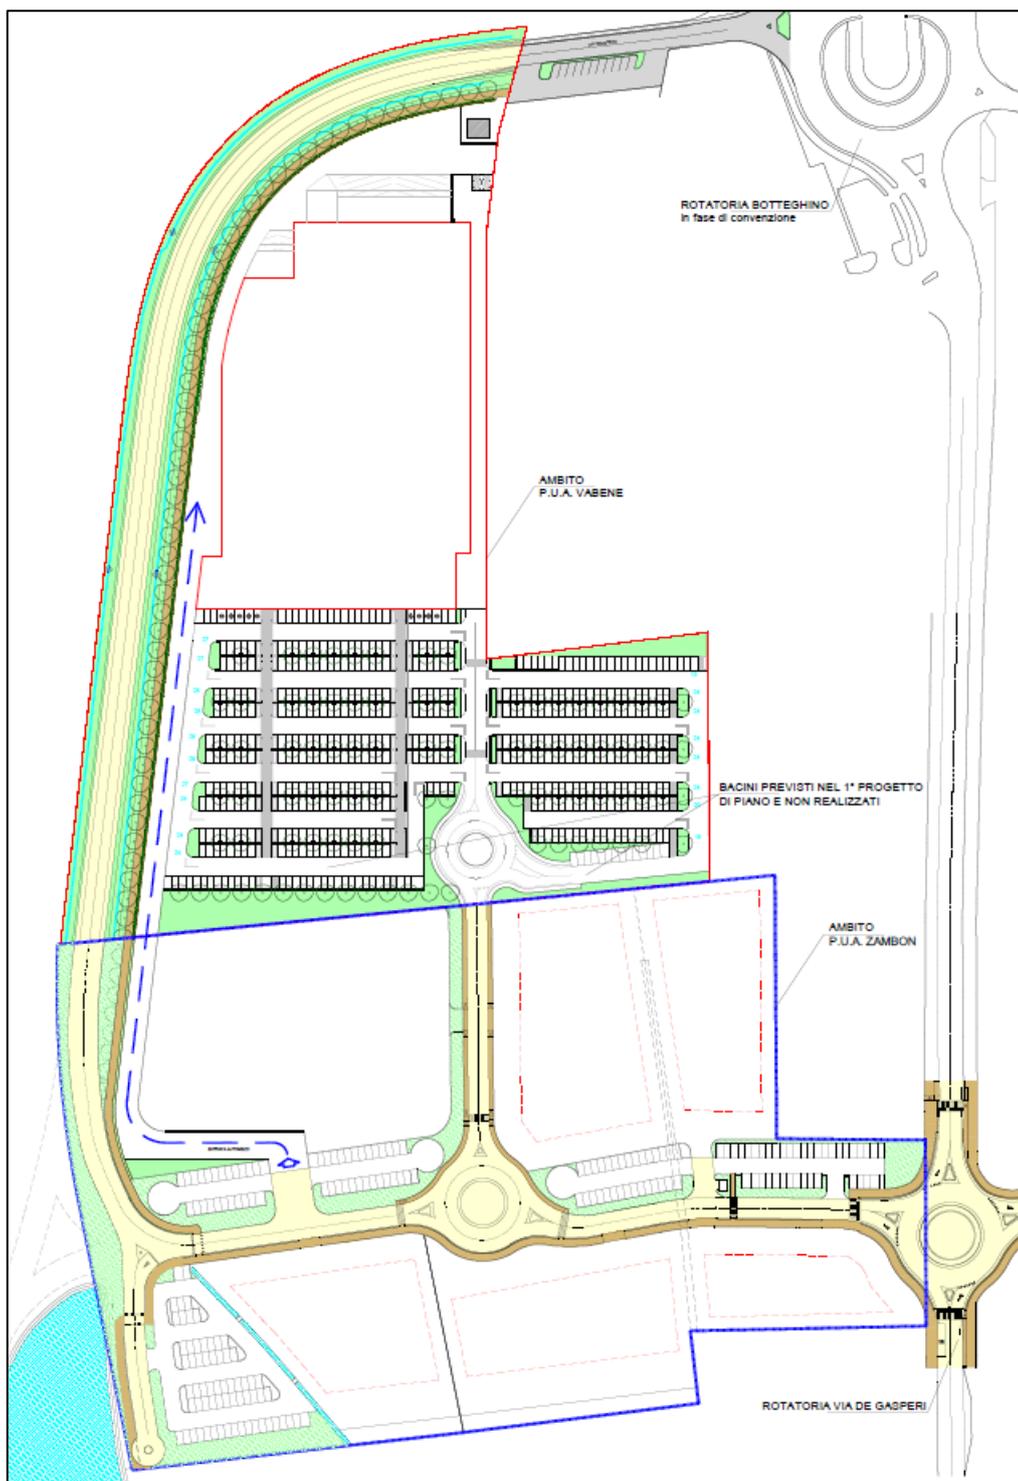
Proposta tragitto ingresso automezzi di approvvigionamento
